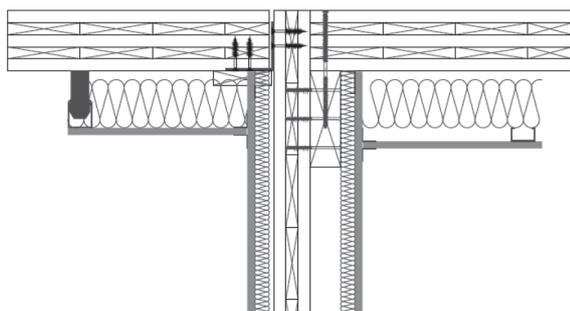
Appui de panneau de plancher sur pièce d'appui métallique ou bois
